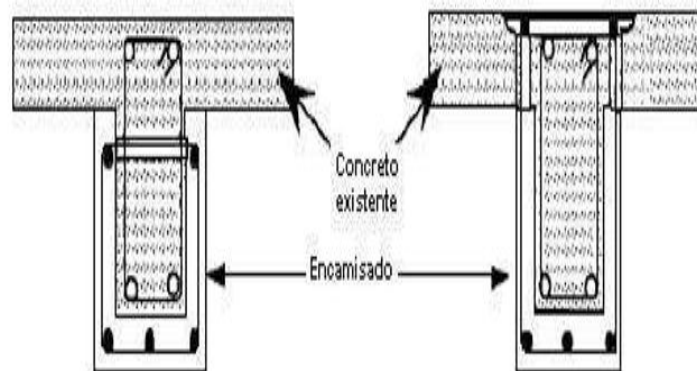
Encamisado de vigas, (Aguilar.; Breñas.; Del Valle, E.; Iglesias.; Picado, M.; James M., 1996)
